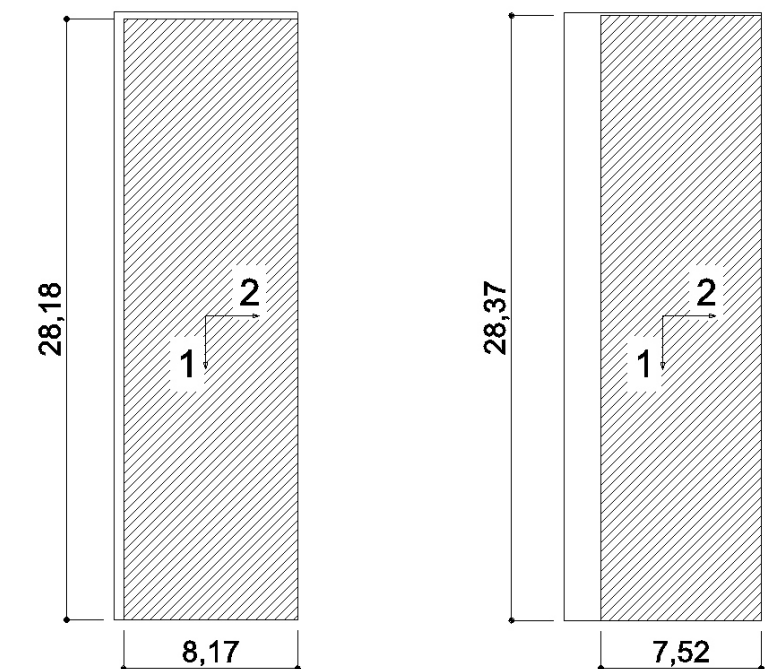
PLANTA DE LAS DIMENSIONES EFICACES DE LA ZAPATA 1 (DERECHA) Y LA ZAPATA 2 (IZQUIERDA)
